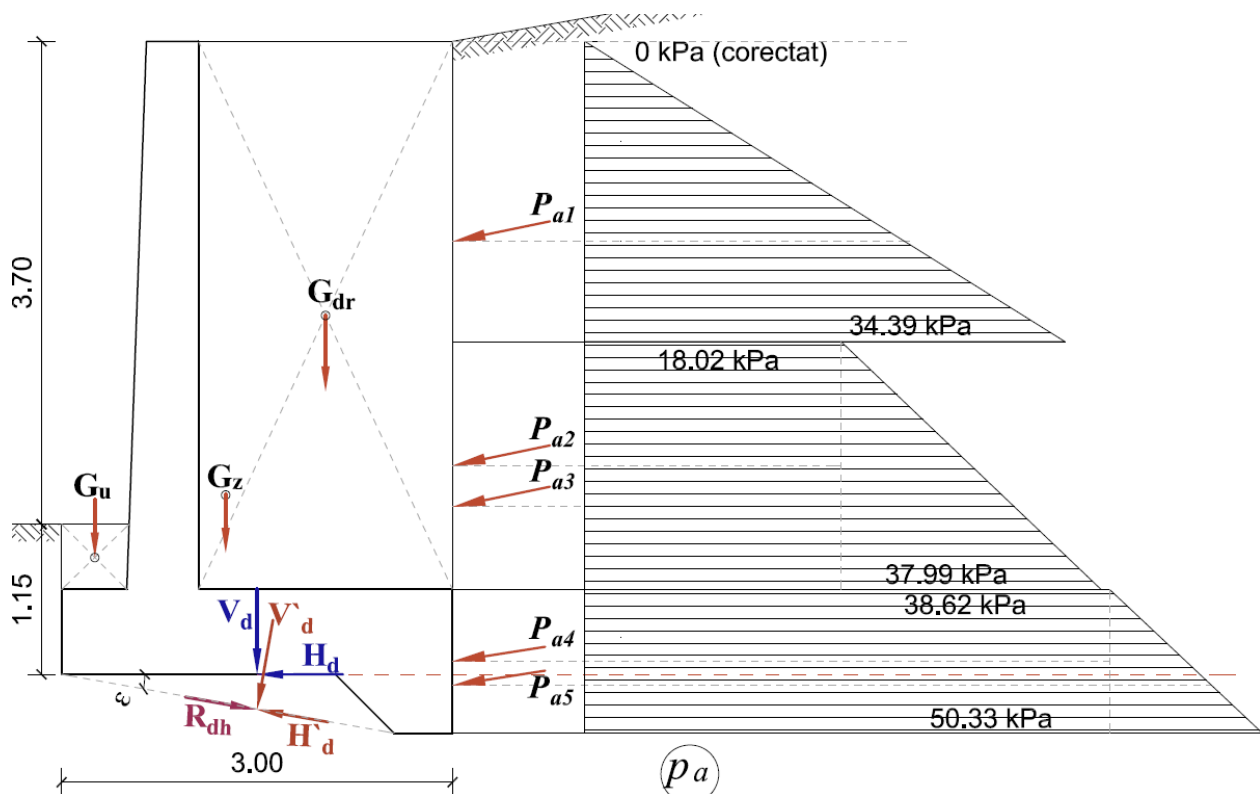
Schemă de calcul – verificare la lunecare (exemplu 2 zid de sprijin din beton armat)
